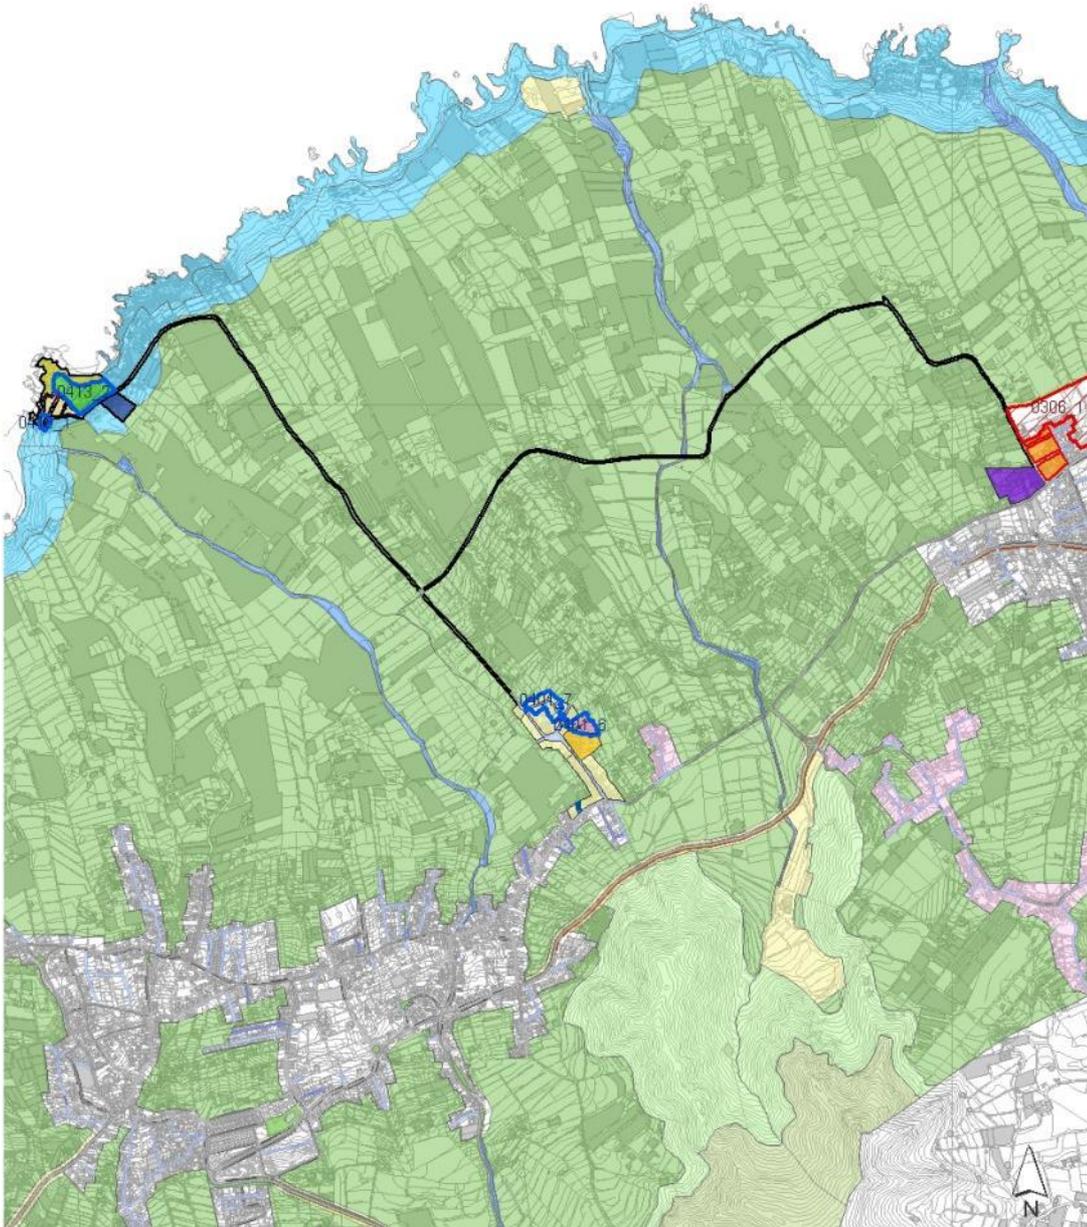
Planta General de la TF-161 Carretera Tejina-La Barranquera
